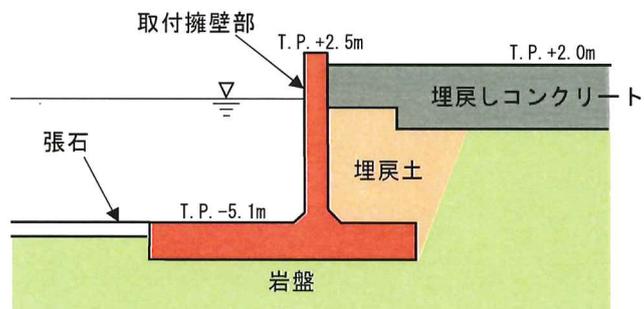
貯水堰断面図 (③-③断面) (取付擁壁部)
